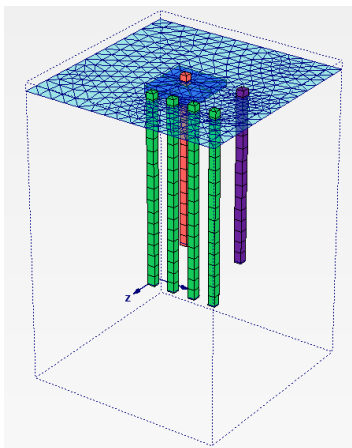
Модель фрагменту пального фундаменту в ПК Plaxis 3D / Model of a pile foundation foundation in SC Plaxis 3D
